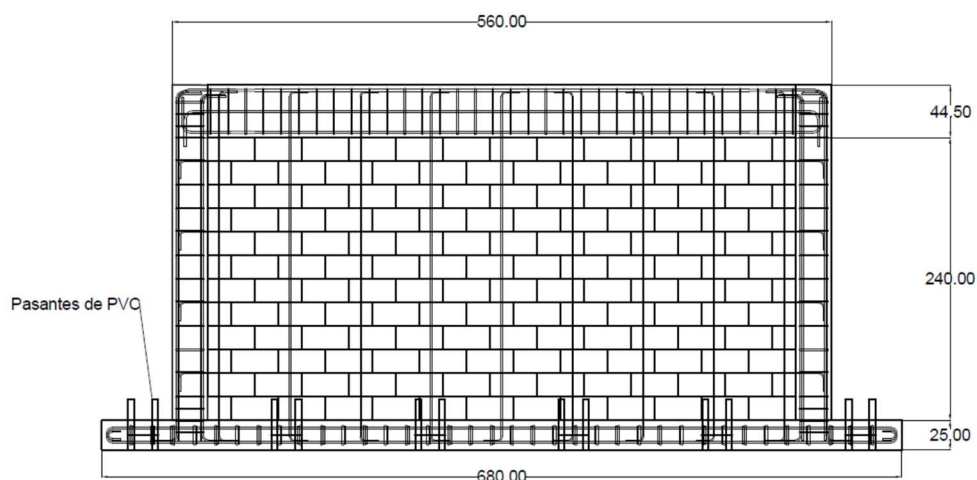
Vista lateral de muro $h/l = 0.5$ con fundación tipo 1 (cotas en cm).
